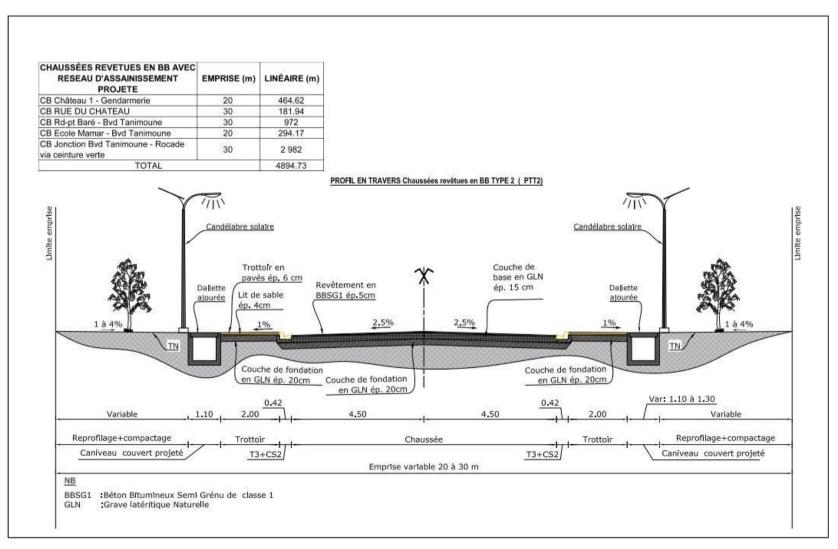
Profil en travers type 2 - Chaussée revêtue en béton bitumineux (PTT-2) Source : PIDUREM, Rapport APD, 2024
